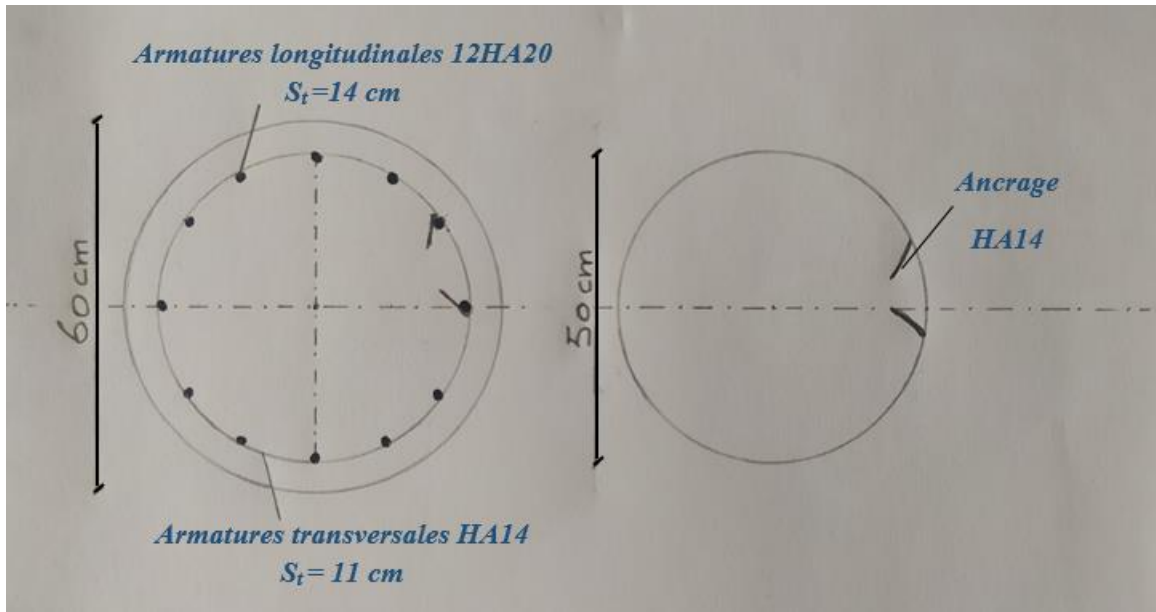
Ferrailage du pieu au niveau de la zone courante.
